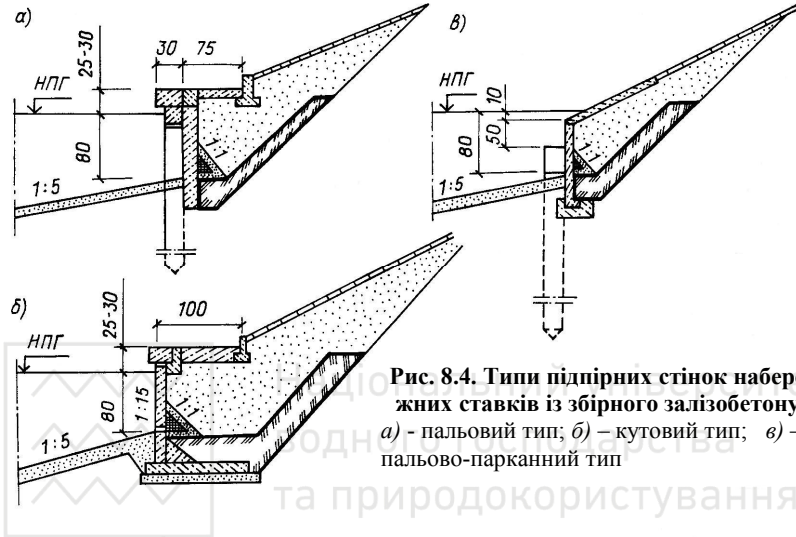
Типи підірних стінок набережних ставків із збірного залізобетону:
